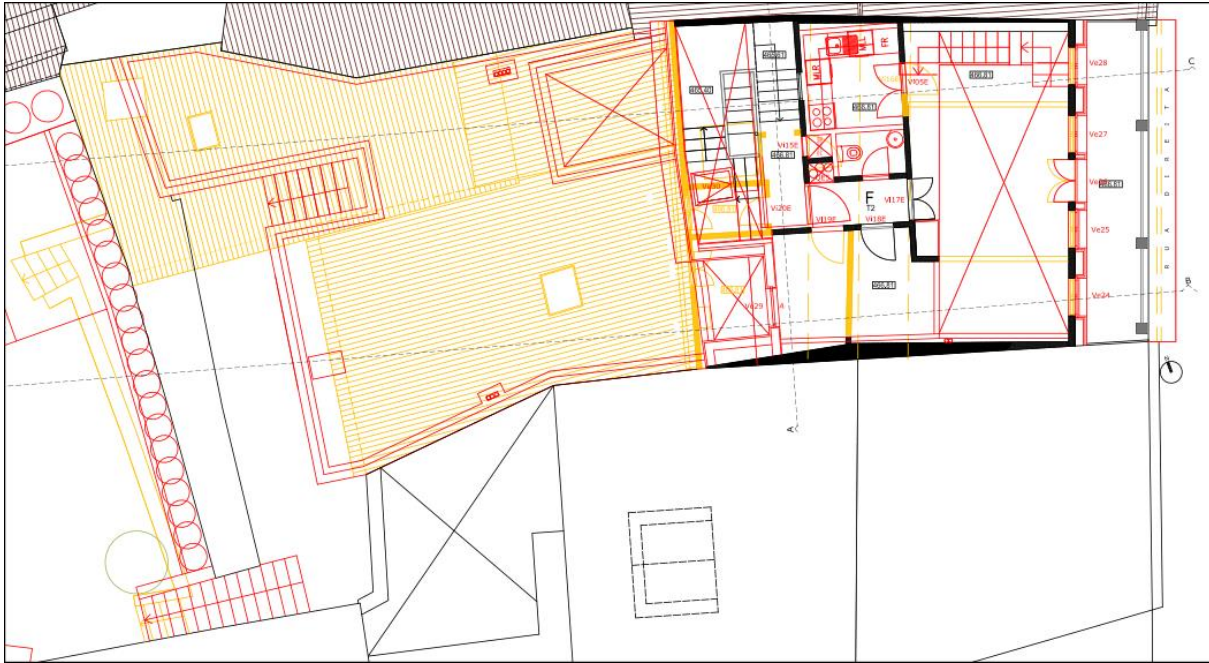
Planta do Piso 3 do edifício 2 em estudo
